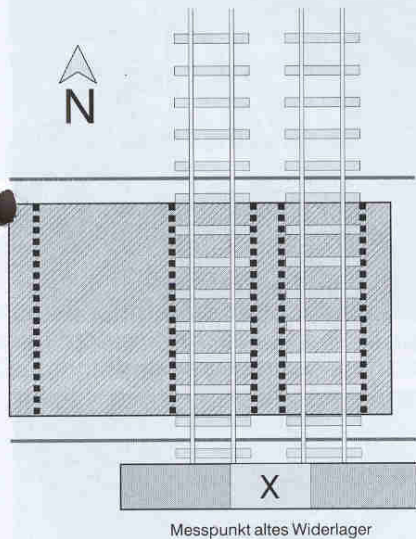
Lageplan und Erschütterungswerte in Steinbach
